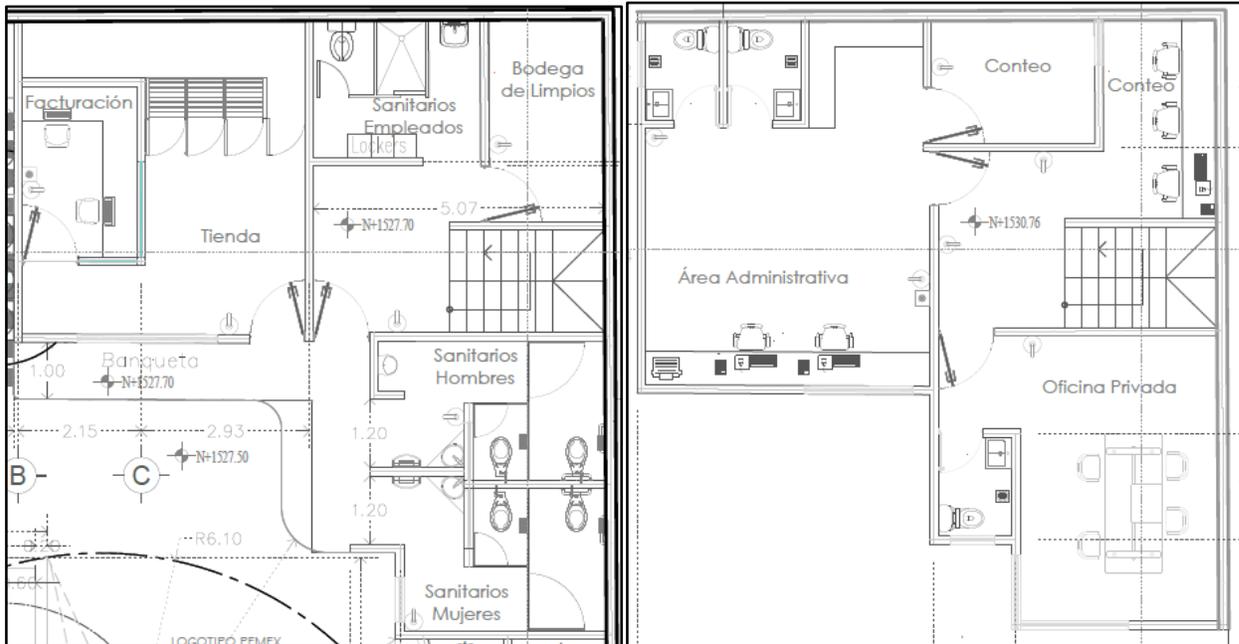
Distribución de los elementos constituyentes del edificio (Planta Baja y Planta Alta).
